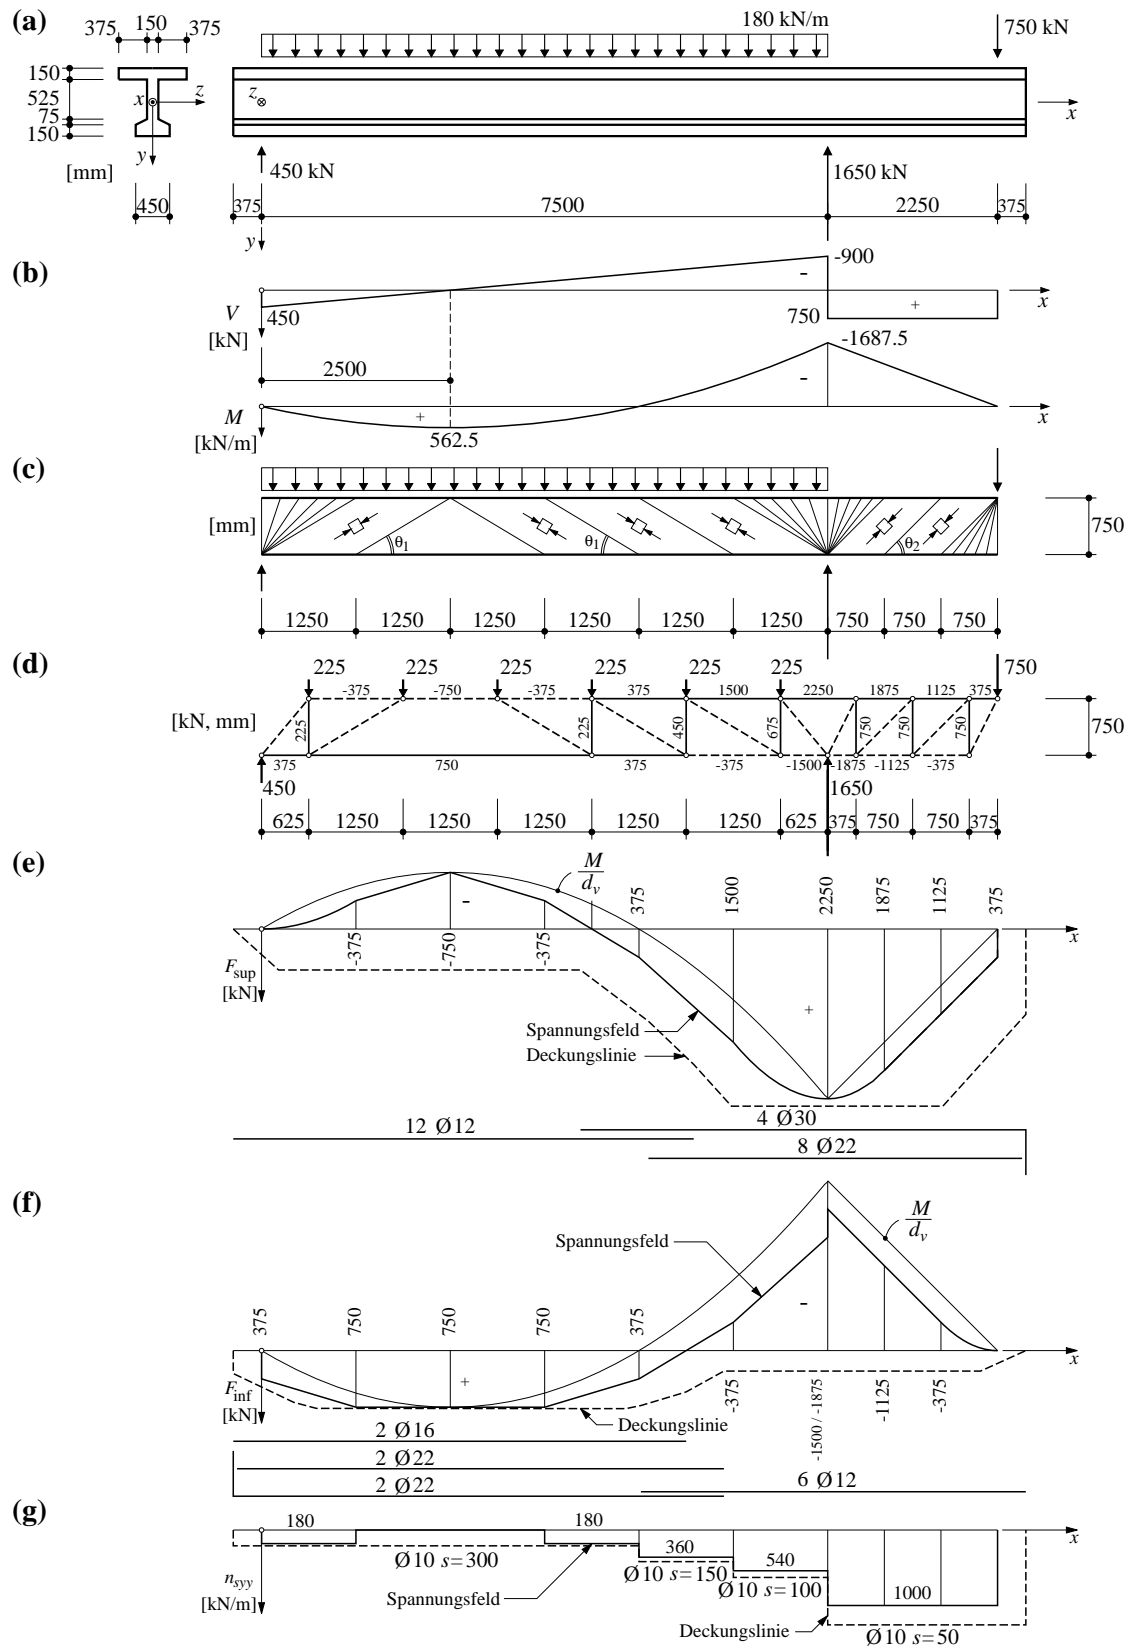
Stahlbetonbiegeträger (Marti 1985): (a) Querschnitt und statisches System mit Einwirkungen; (b) Schnittkraftverläufe; (c) Spannungsfeld; (d) Fachwerkmodell; (e) oberer Stringer mit zugehöriger Bewehrung; (f) unterer Stringer mit zugehöriger Bewehrung; (g) Querkraftbewehrung.
